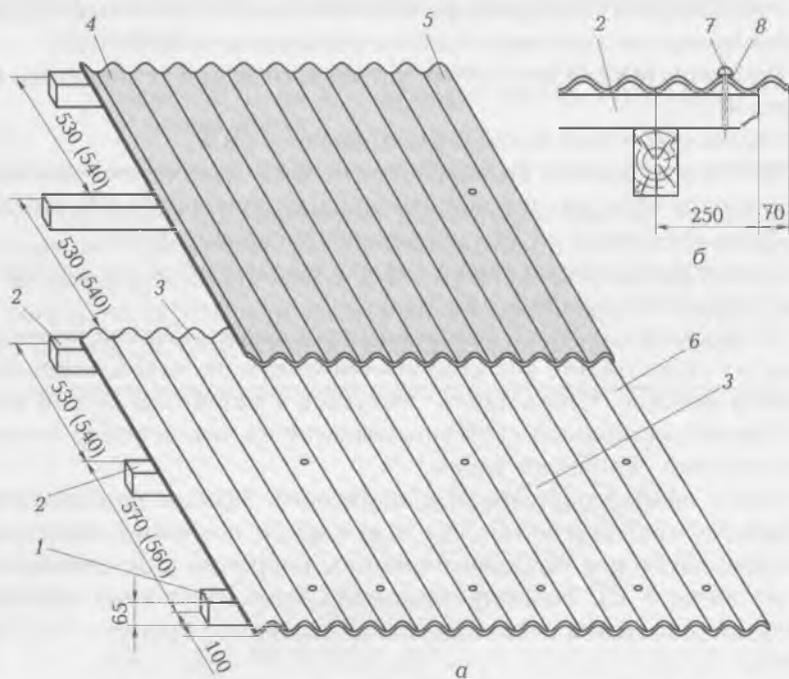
Устройство кровли из волнистых асбоцементных листов: а — начальная стадия для укладки листов; б — поперечный разрез фронтового свеса; 1 — карнизный брусок; 2 — обрешетка; 3 — сливной лист; 4 — рядовой лист; 5 — фронтовый лист; 6 — угловой лист; 7 — гвоздь; 8 — резиновая шайба
